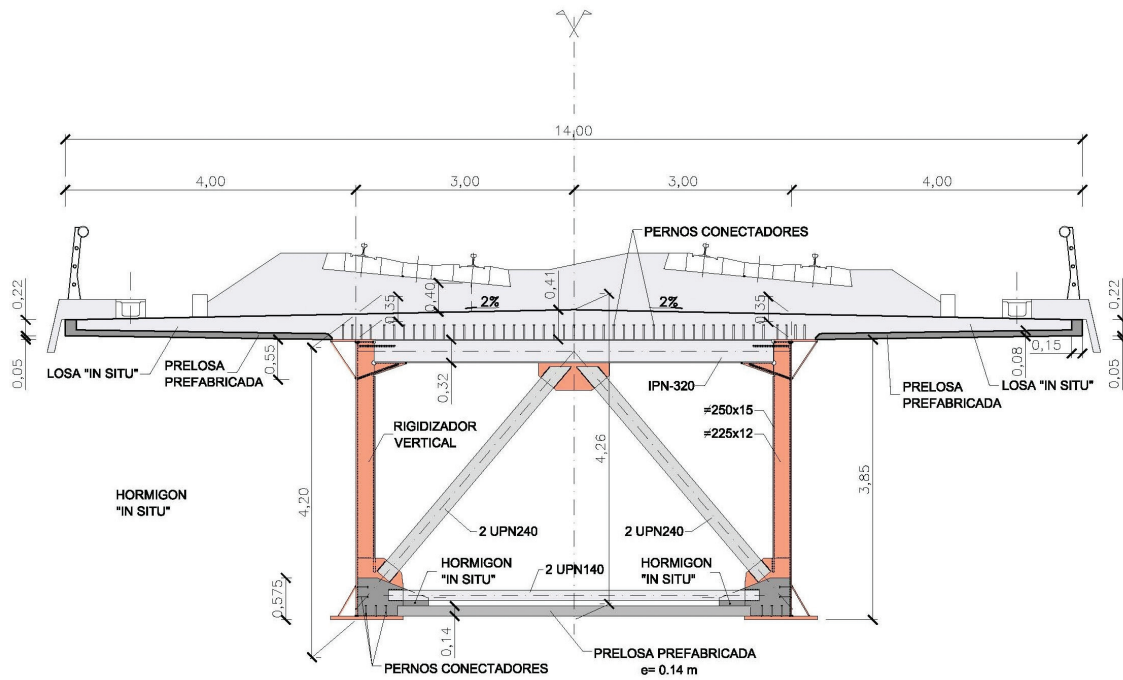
Sección transversal tipo en zonas de centro de vano.
